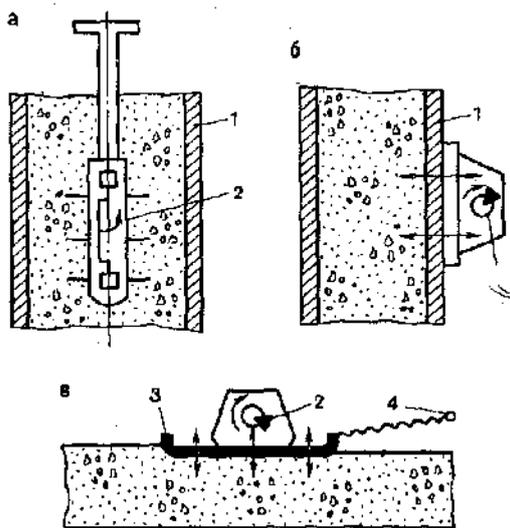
Типы вибраторов : а – внутренний (глубинный); б – наружный; в – поверхностный; 1 – опалубка; 2 – дебаланс; 3 – рабочая площадка; 4 – гибкая тяга для перестановки поверхностного вибратора.
